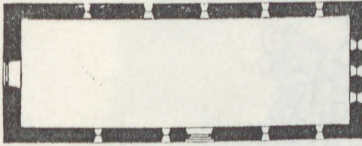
Stresow; Kirche, Grundriss vor 1897. 1 : 500.
